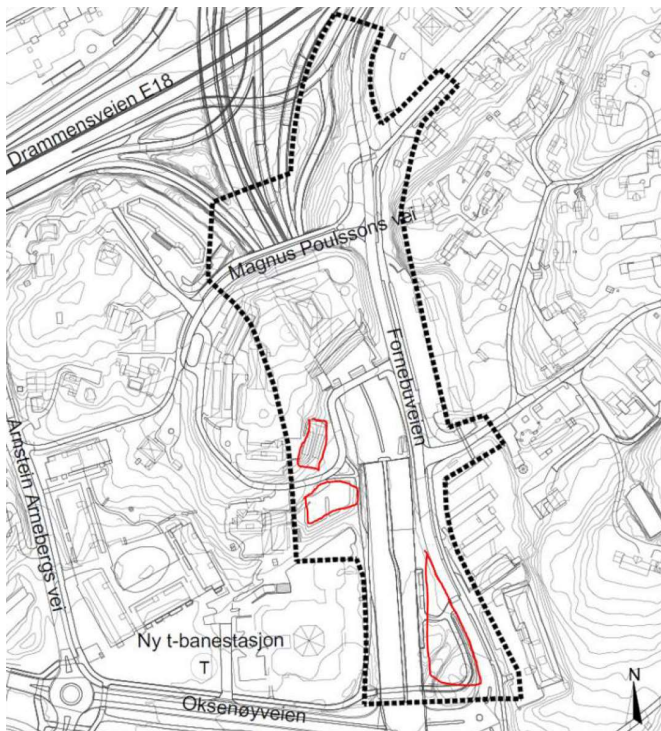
Sikringssone 10 m fra ytterkant av eksisterende veikulvert
